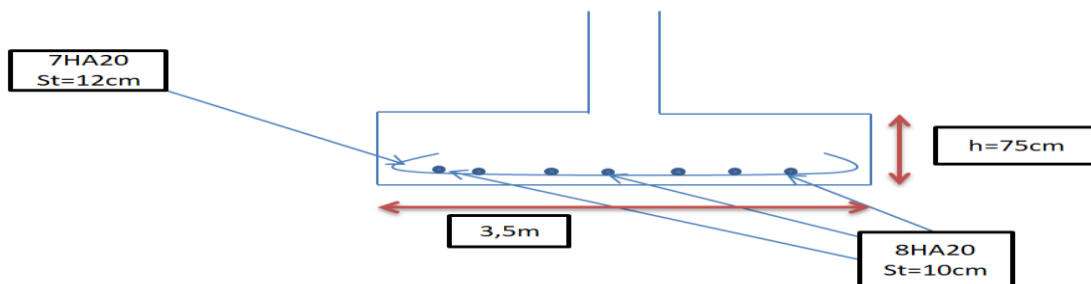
ferrailage de semelle filante  $S_{f2}$
